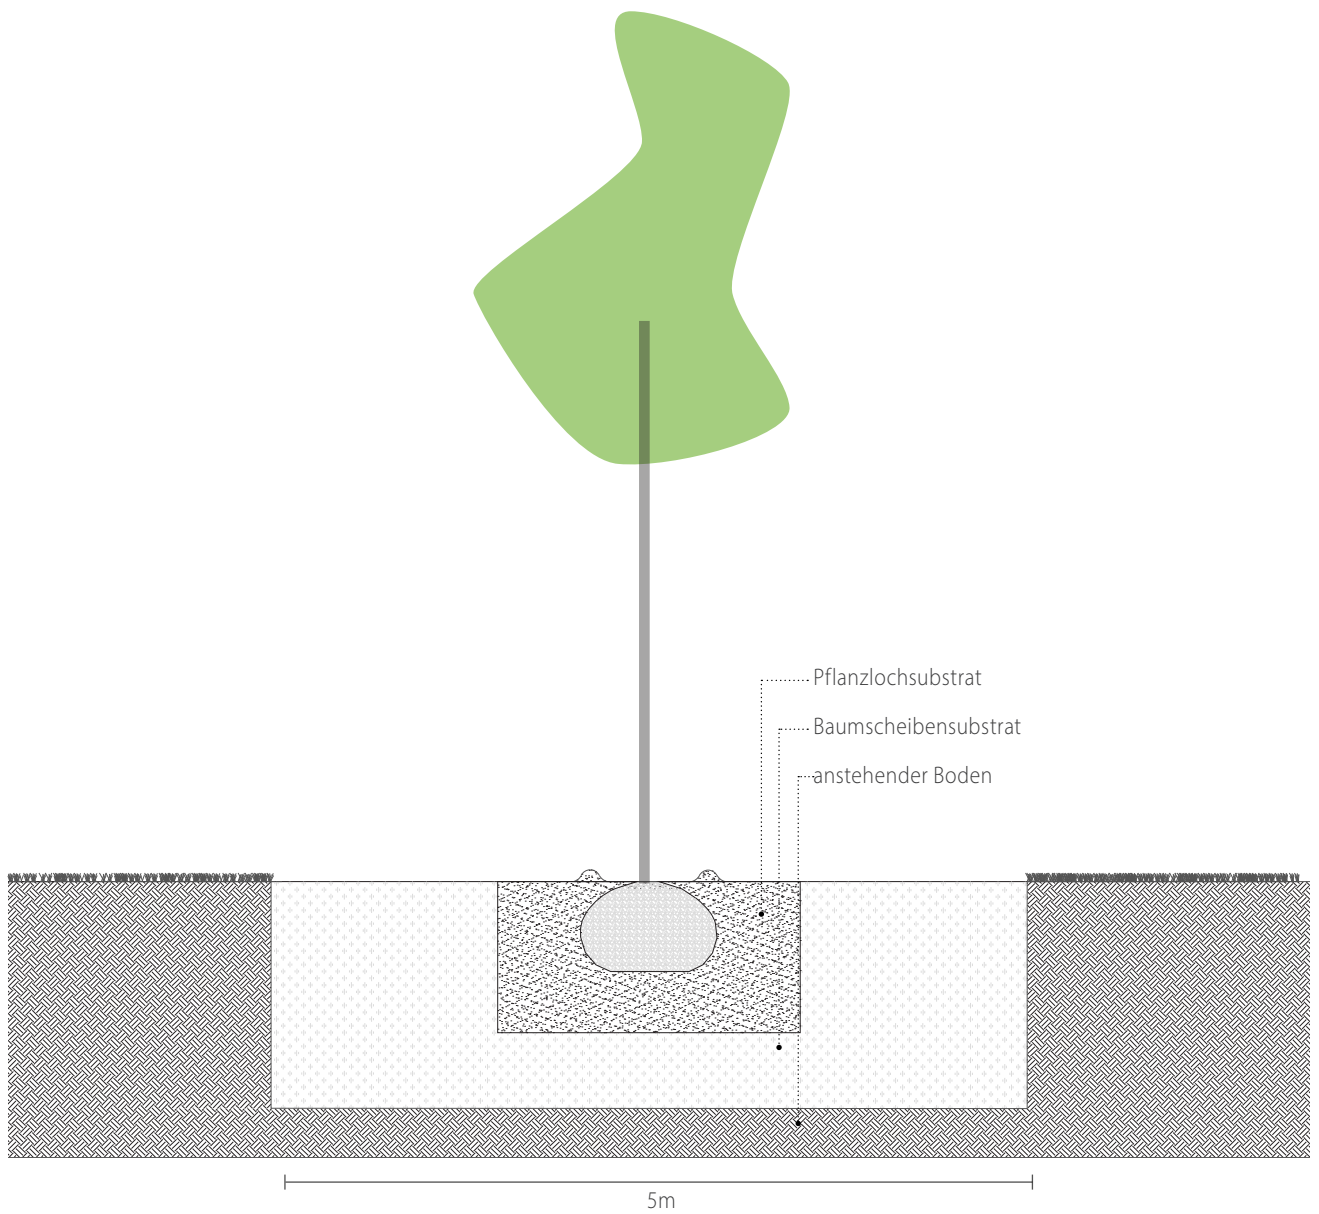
Detailsicht Bauweise 1: Schnittansicht
